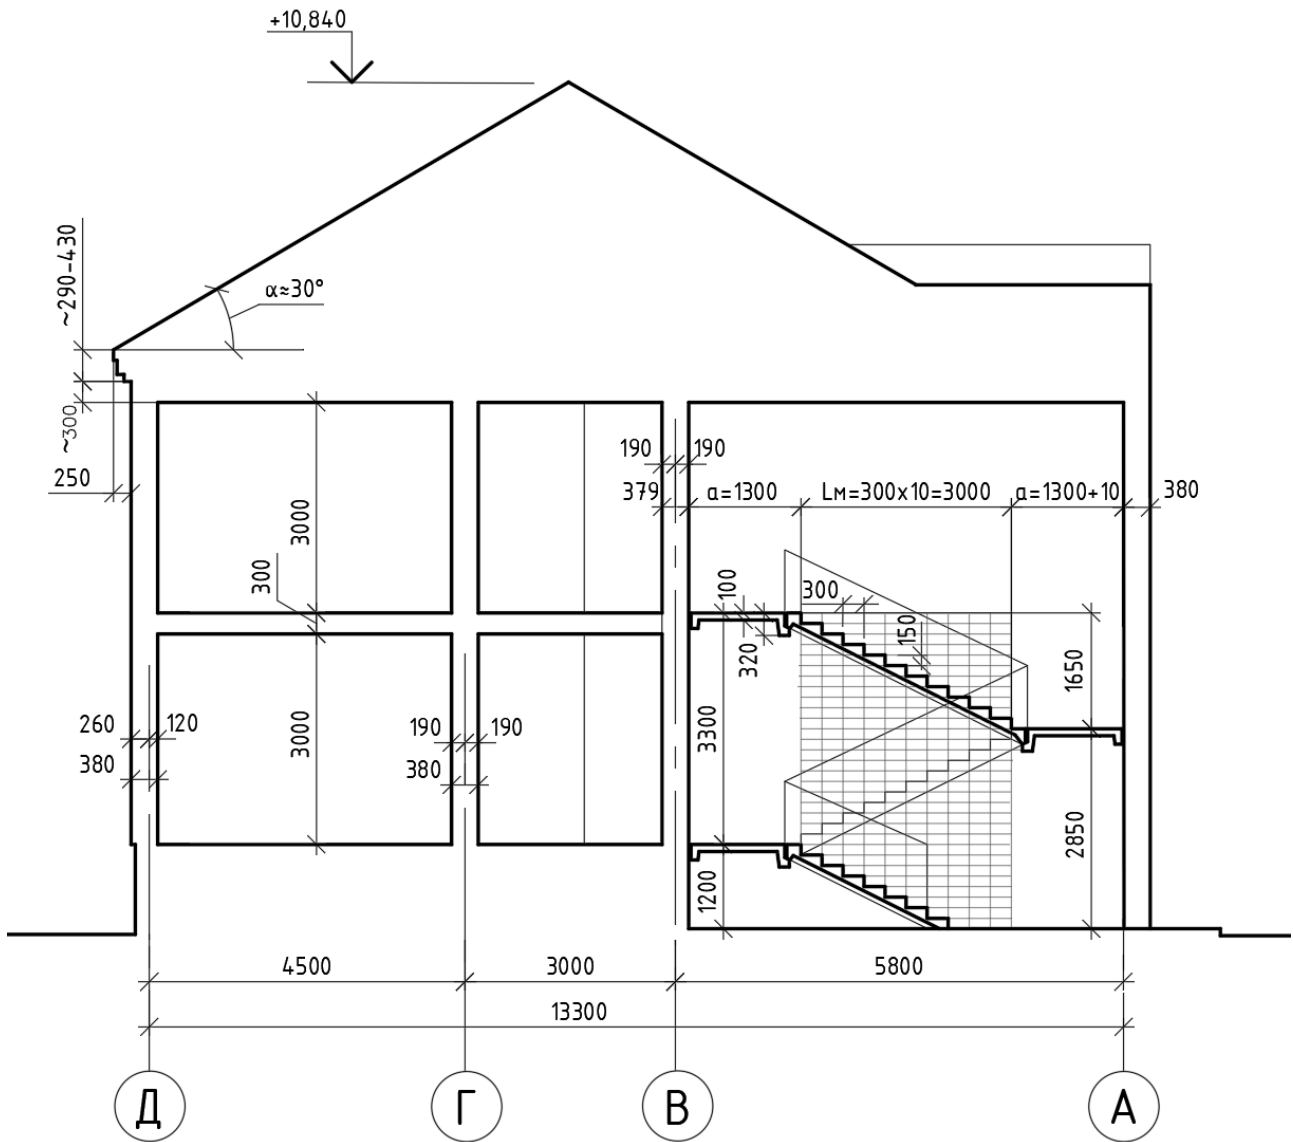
Побудова розрізу будівлі без нанесення прорізів вікон та дверей і з вказівкою розмірів стін, даху, перекриття та сходів
